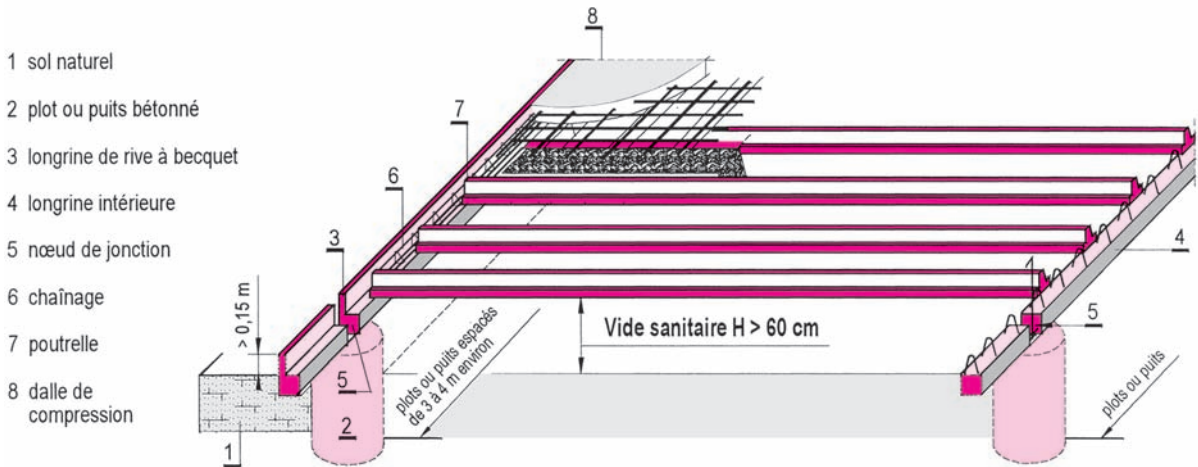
Fondation sur puits, longrines et plancher sur vide sanitaire
